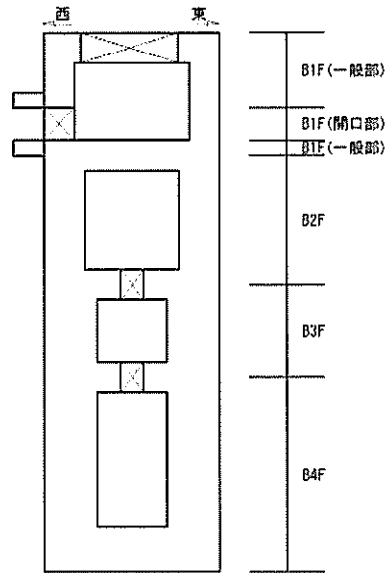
(1) 概略配筋図 (東西方向断面)
